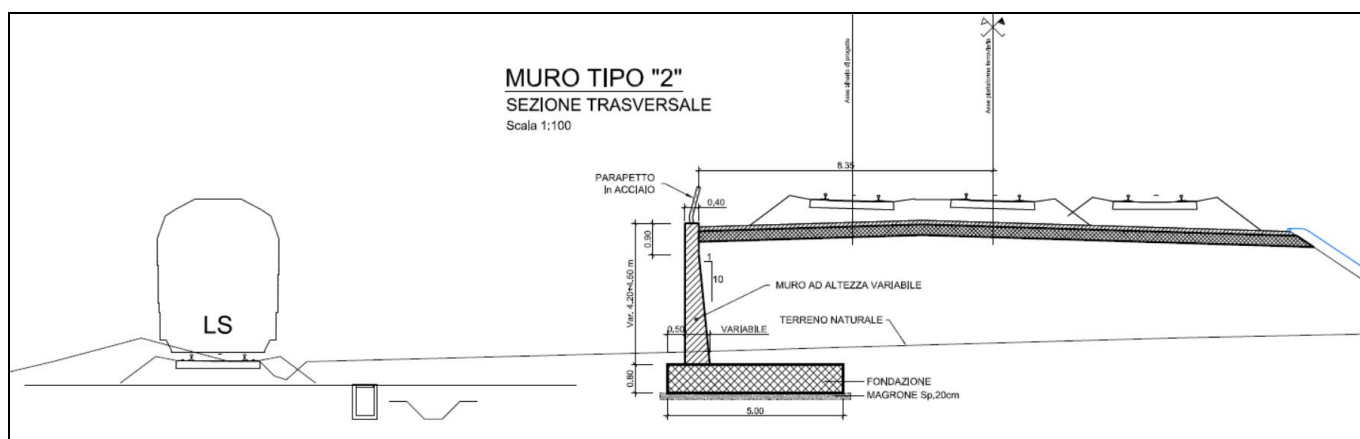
RI05: Muro di sostegno in sx MU06 – Sezione trasversale muro tipo 2.
